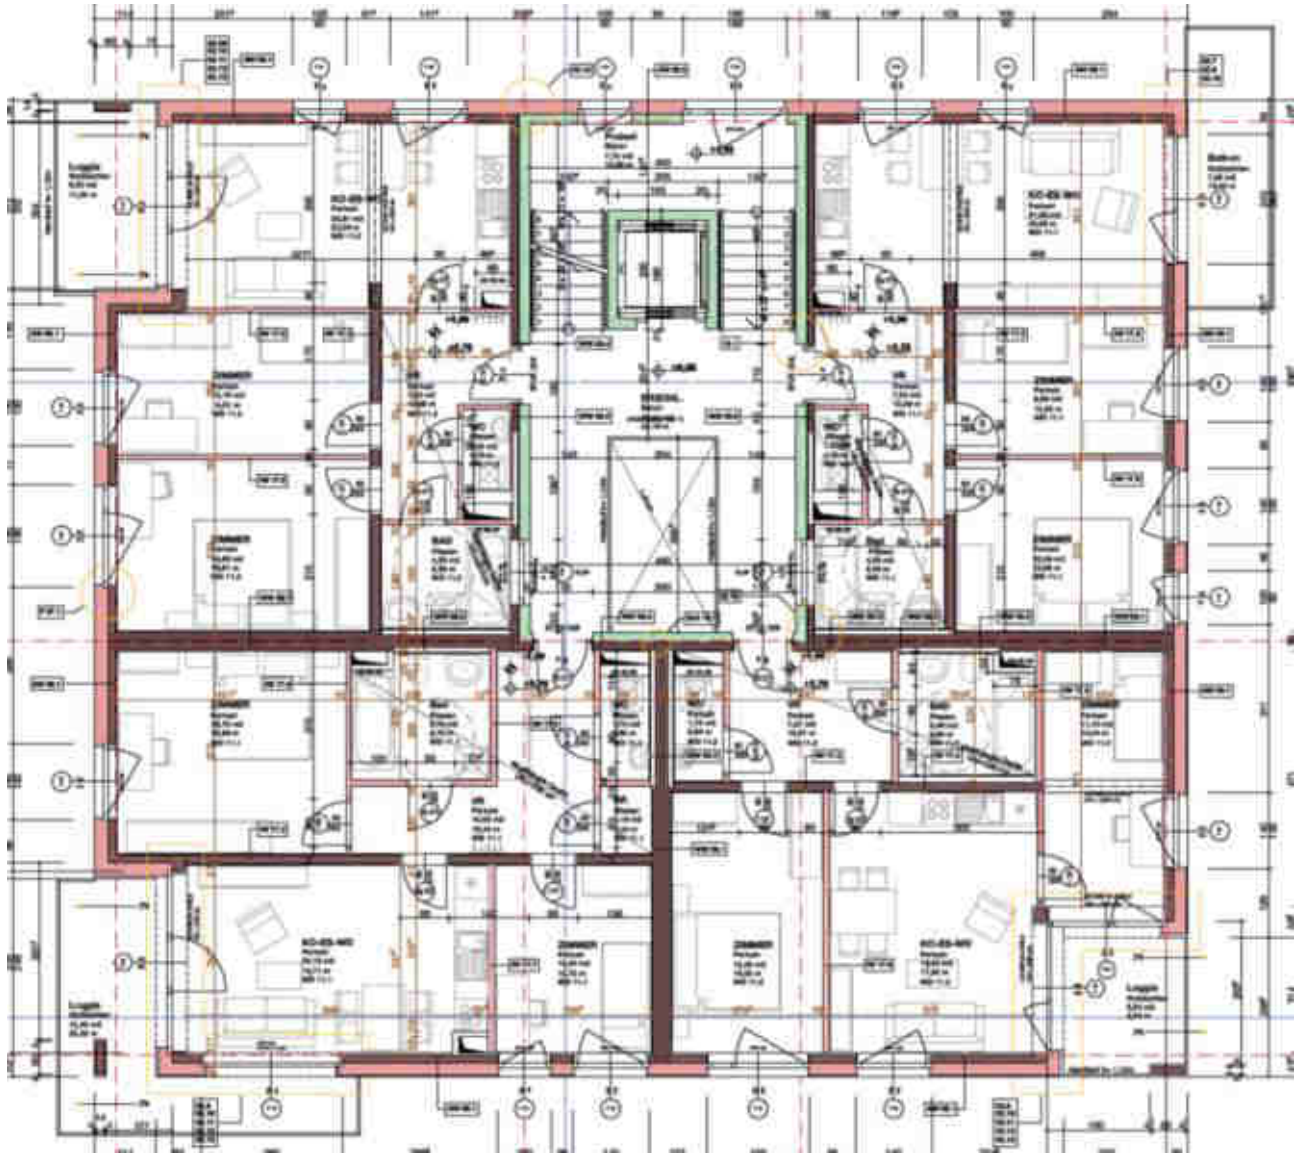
Grundriss 2.OG, Haus E und G. Quelle: Nussmüller Architekten ZT GmbH
